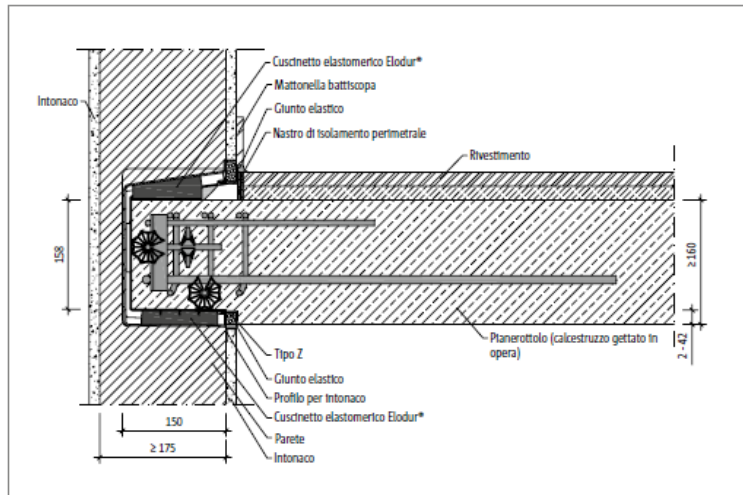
Schöck Tronsole® tipo Z-V+V-T: sezione costruttiva - Planerottolo in opera
